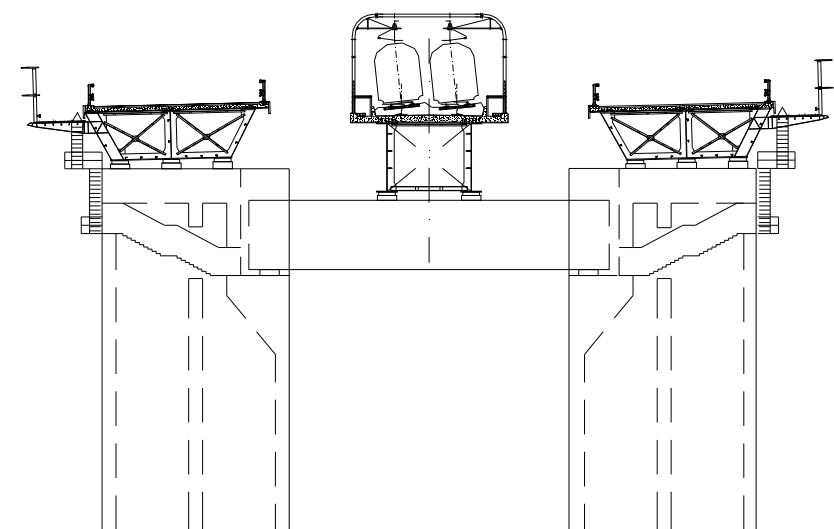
Proposta intermedia - sezione trasversale dell'impalcato ferroviario e stradale in corrispondenza della pila
